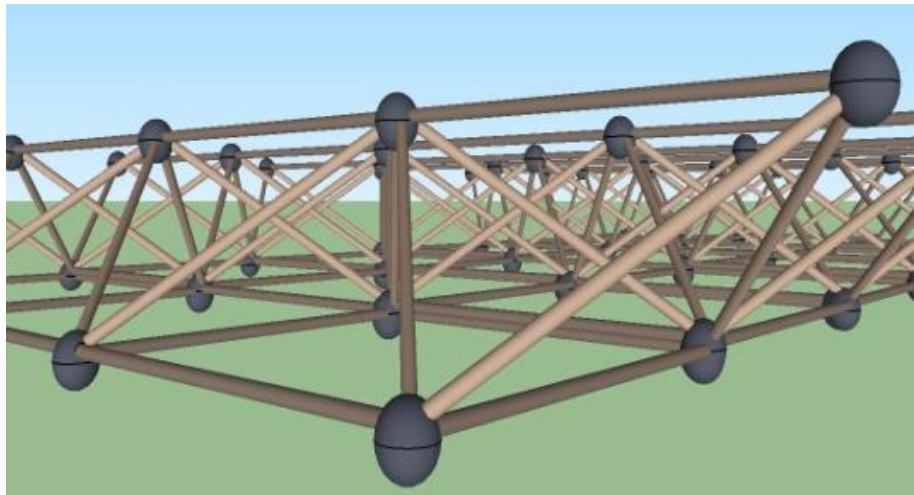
, Penerapan Deasain Struktur Rigid Frame.
